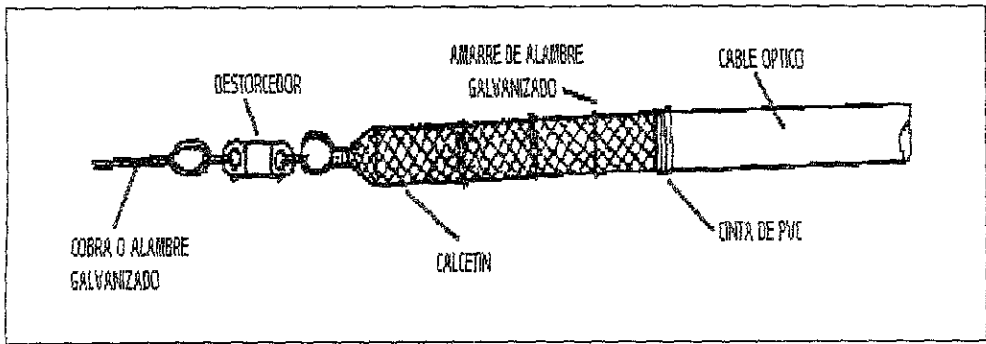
Jalado del cable óptico con calcetín.
